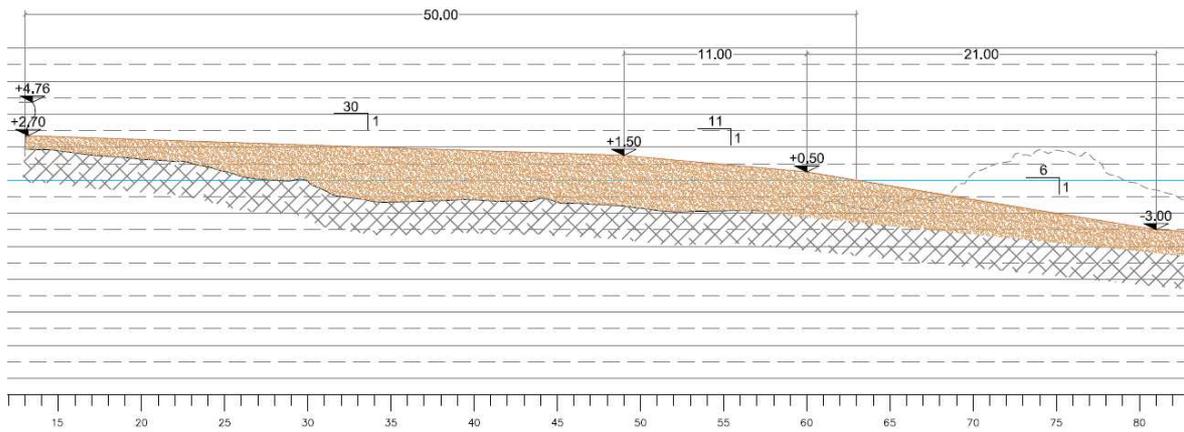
sezione tipologica del ripascimento - lato terra (sezione 13)
